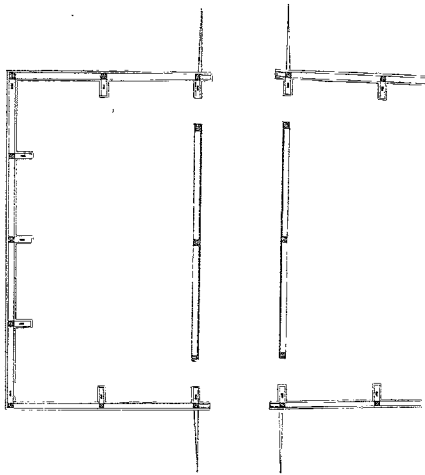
Grundriß einer Fachwerks-Scheune mit Querterrenne.
